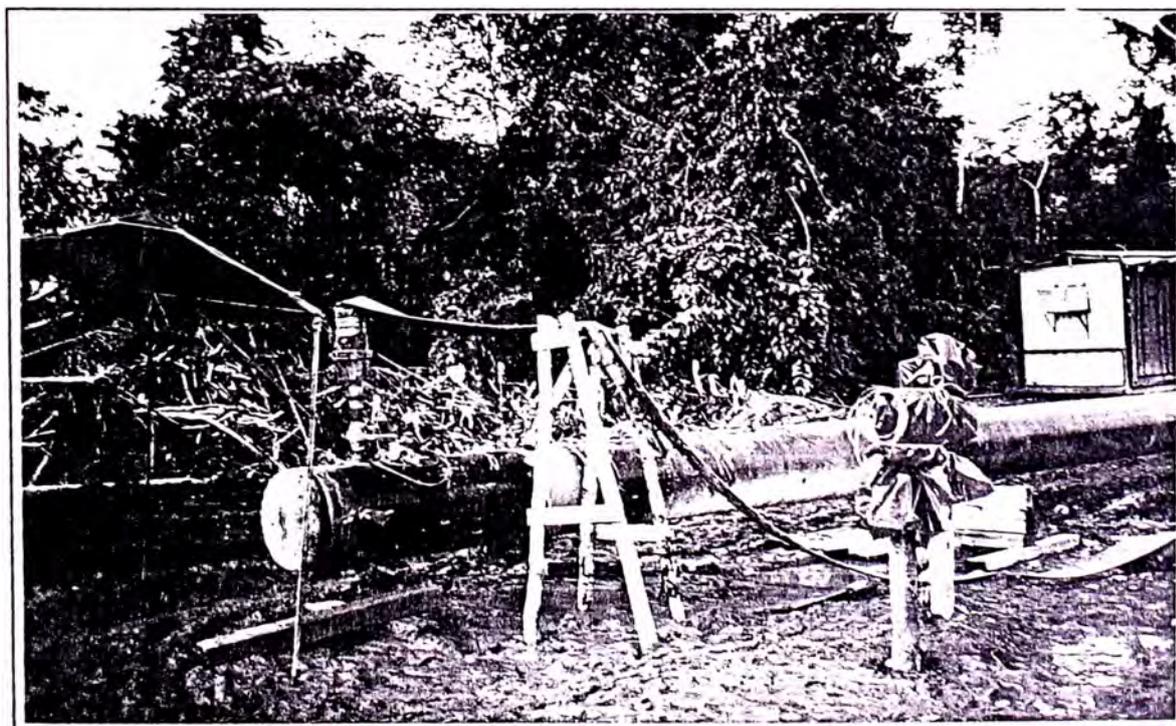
Cabezal anterior montado e instalando accesorios para prueba hidrostática.
